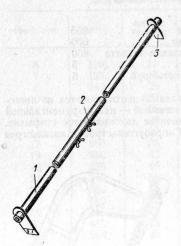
1—башмак винта; 2—головка винта; 3—скоба; 4—винт
